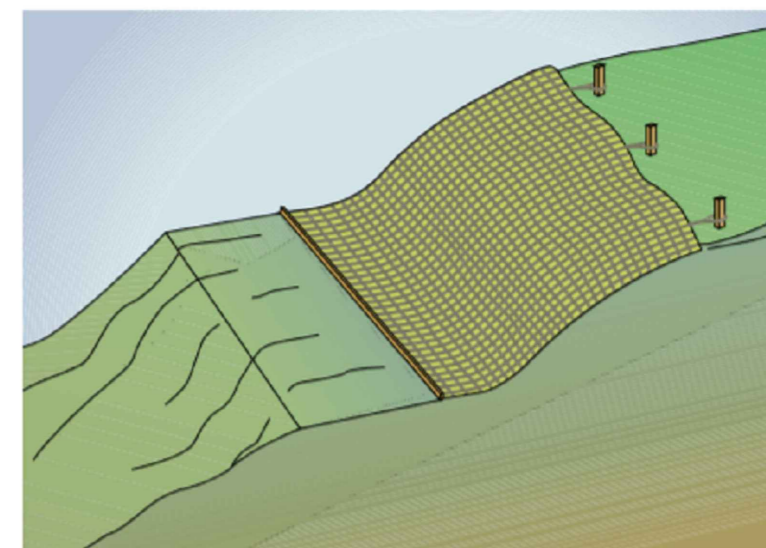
Escavação protegida – com estruturas denominadas "cortinas"
